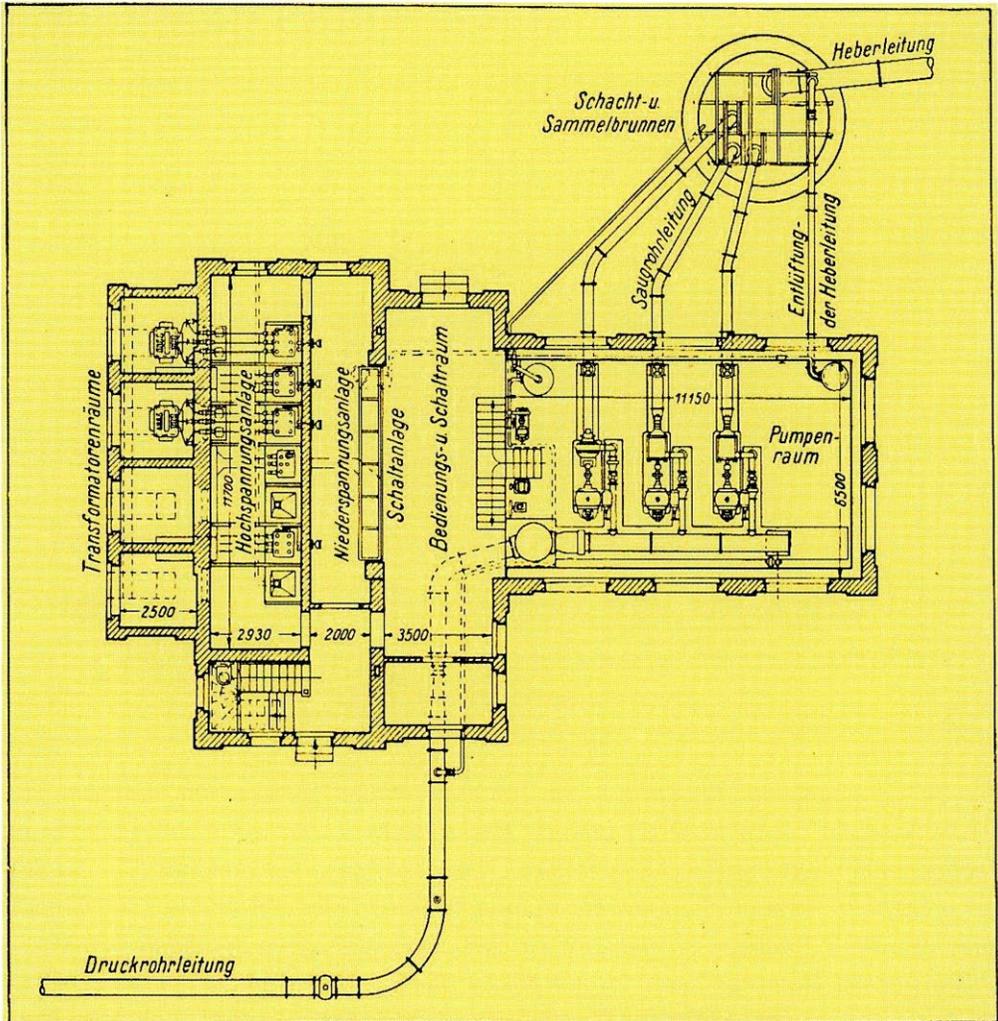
Das Wasserwerk Fortuna. Grundriß.
